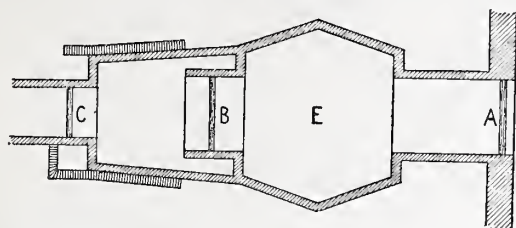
Grundriss vom Einlauf des Emissars des Fuciner-Sees. (Schematisch.)
